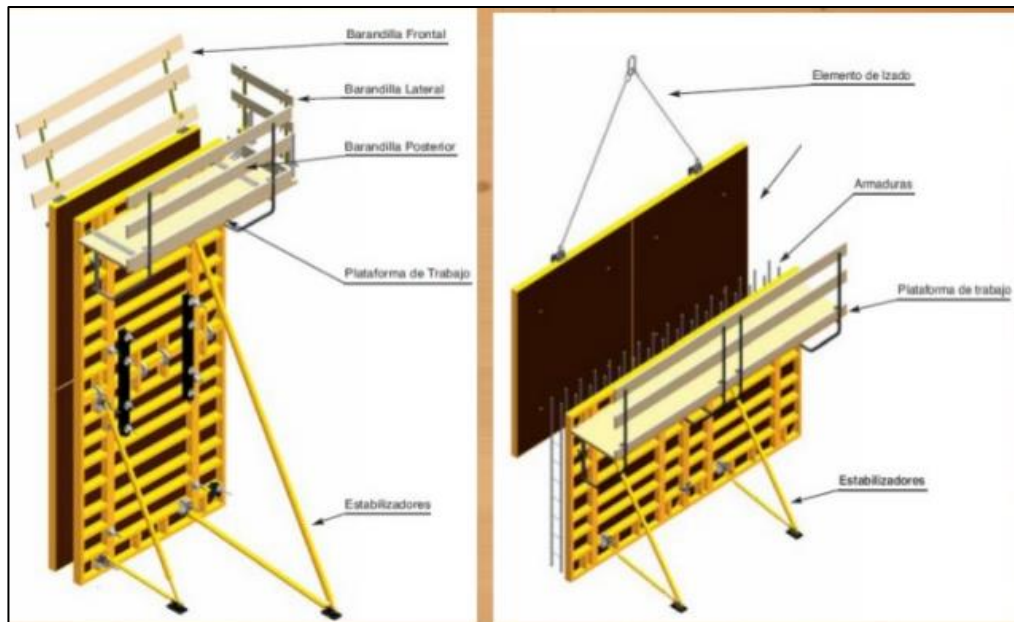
6 Encofrado en Metálicos (Alva Yosep, 2014)
